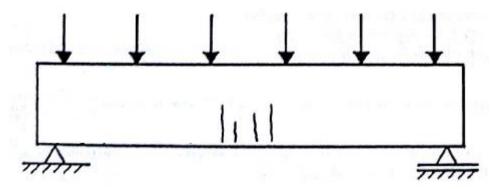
Imagem de modelo de fissura (THOMAS)
